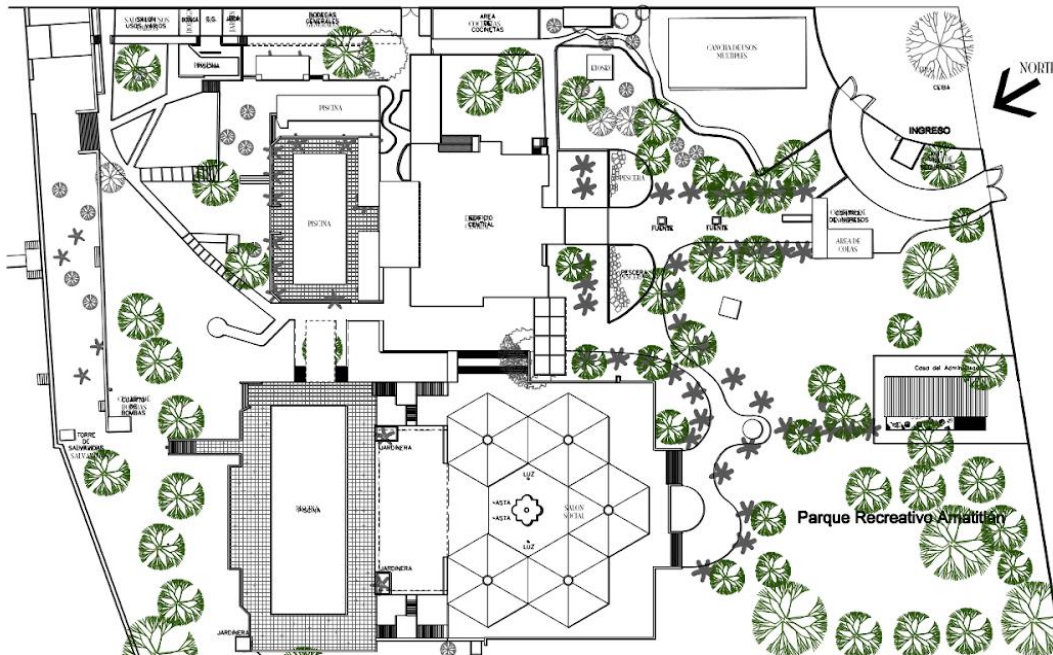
Planta de conjunto IRTRA Amatitlán
